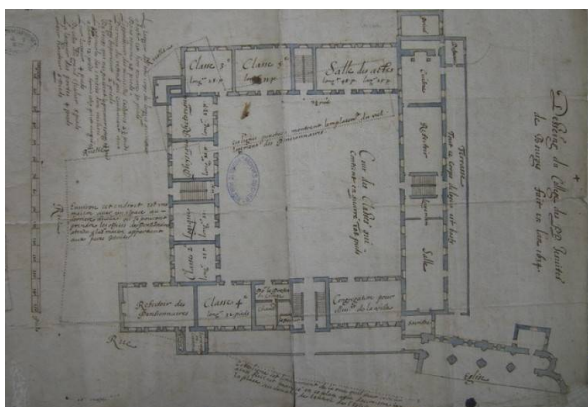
Plan du collège Sainte-Marie à Bourges en 1634.
